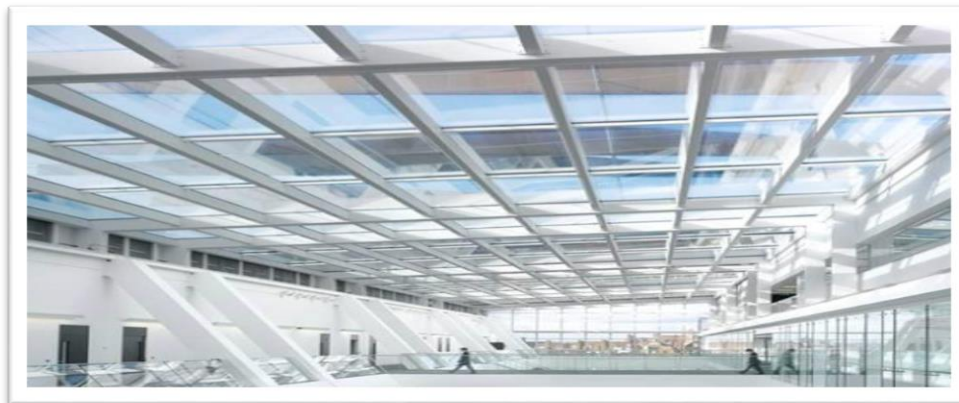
exemple de mur rideau utilisé pour la toiture
